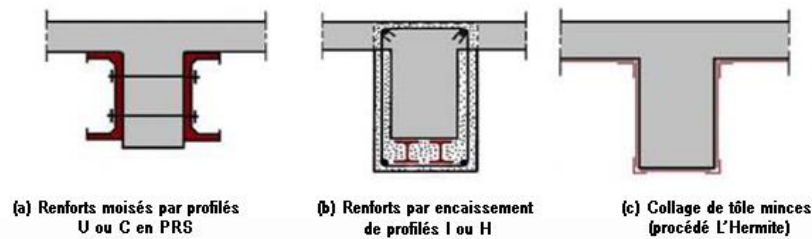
Consolidation de poutres en béton armé par adjonction de profilés en acier.
